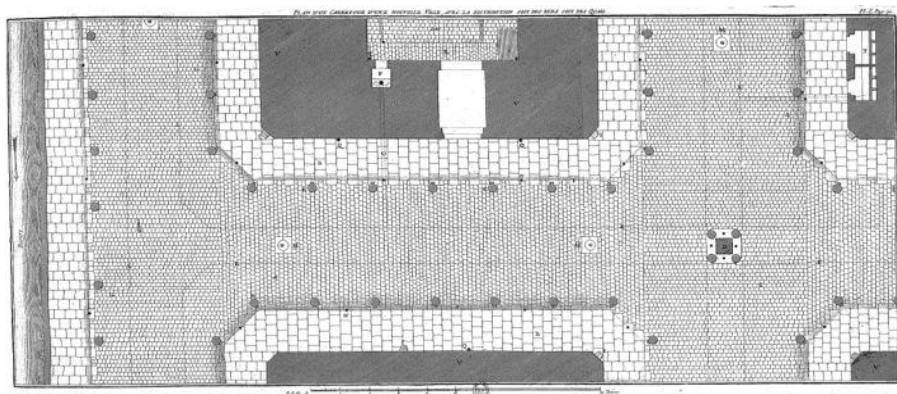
> Planta de una calle donde se puede ver el pavimento propuesto por Patte diferenciando el pavimento de las aceras construido con losas de piedras respecto de las calzadas pavimentadas con adoquines (Patte 1769, p. 83)
